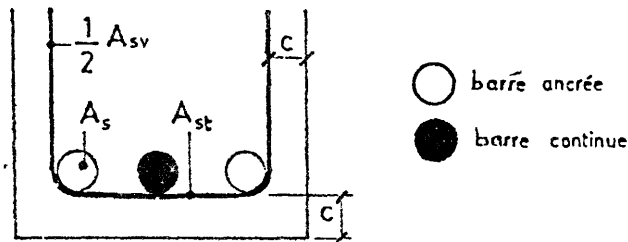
Armature complémentaire dans une zone d'ancrage quand le diamètre des barres est supérieur à $\boxed{32}$ mm et qu'il n'existe pas de compression transversale.
